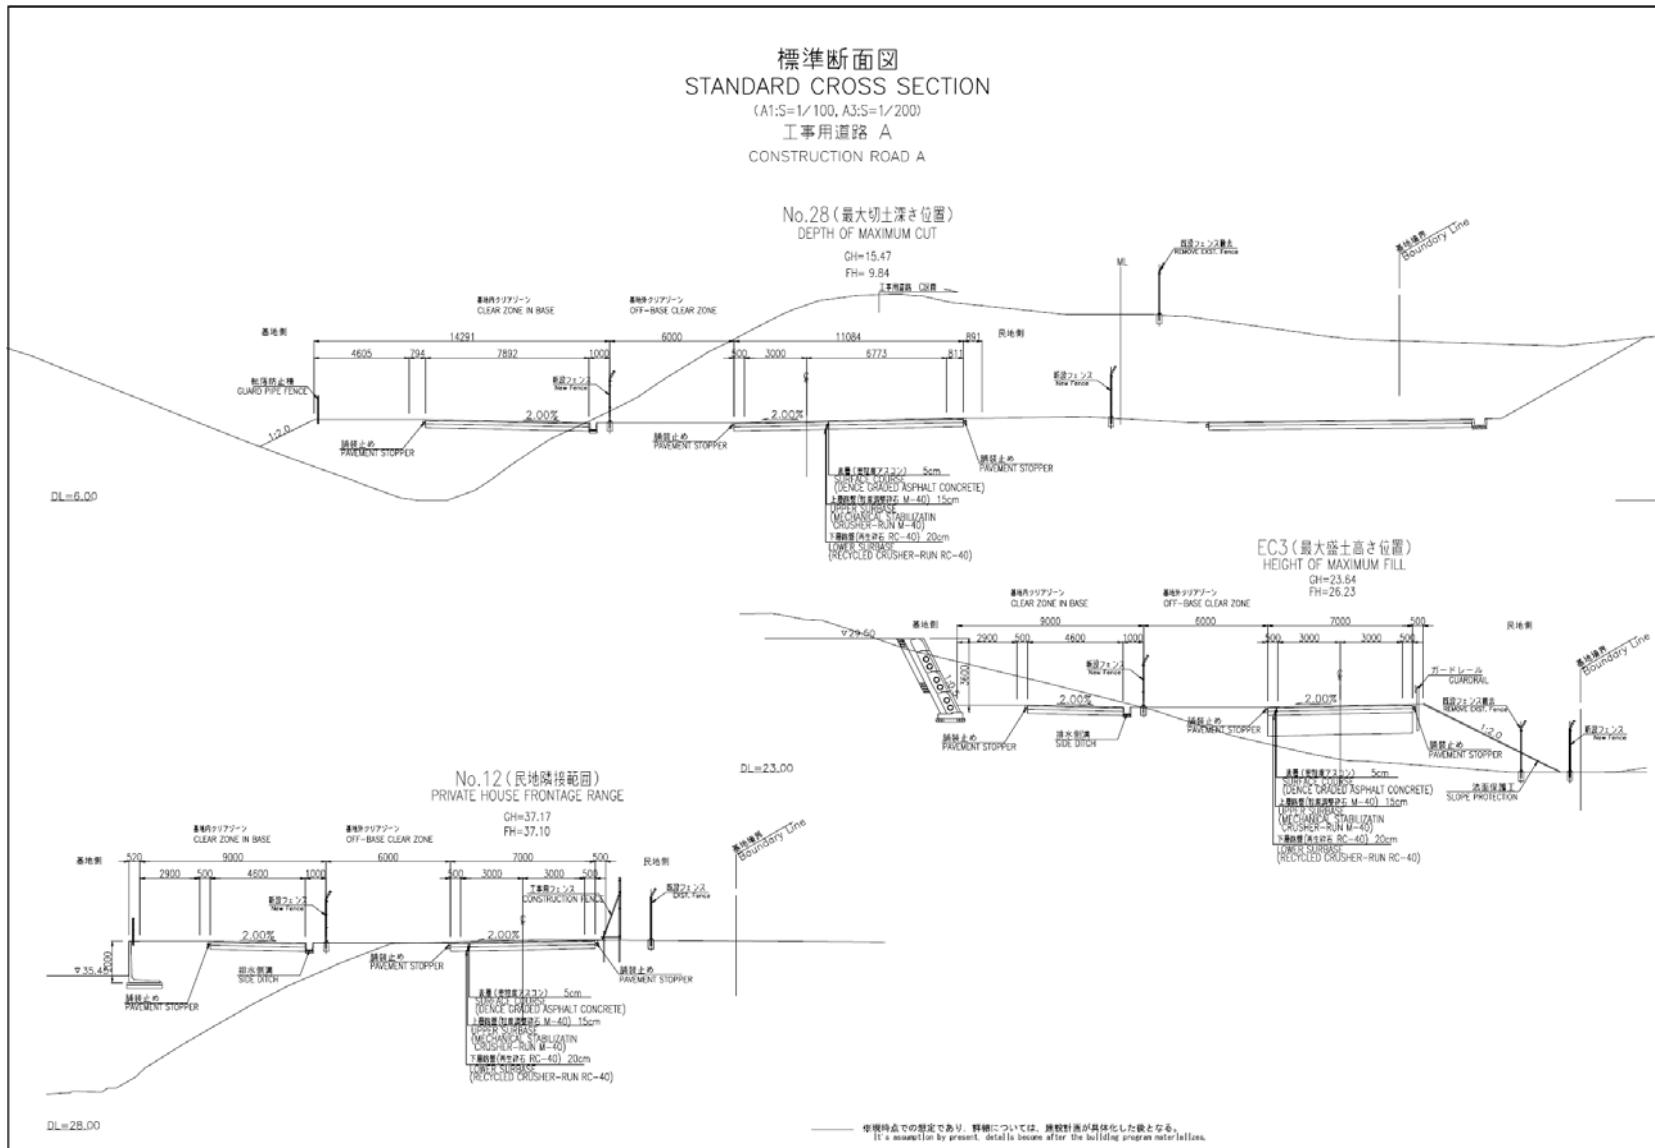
(1) 工事用仮設道路標準断面図 (A区間)
